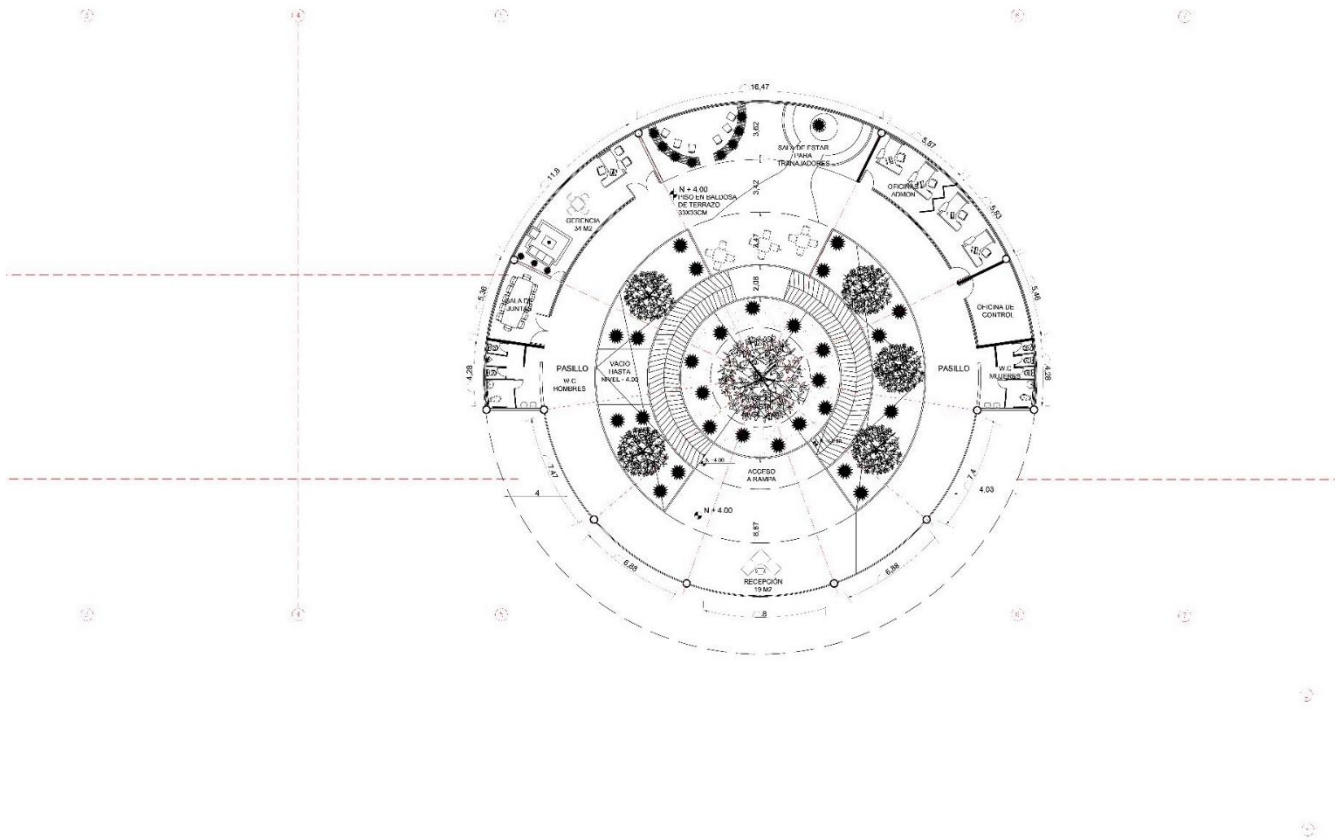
Planimetría amoblada nivel -4.00 parte 2.
